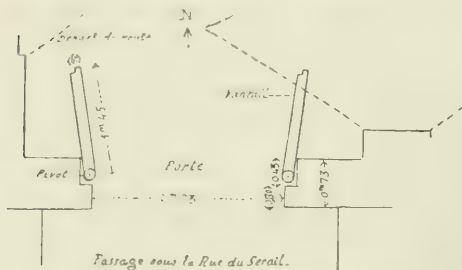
Plan de Bâb Yaqoub. Etat actuel.
